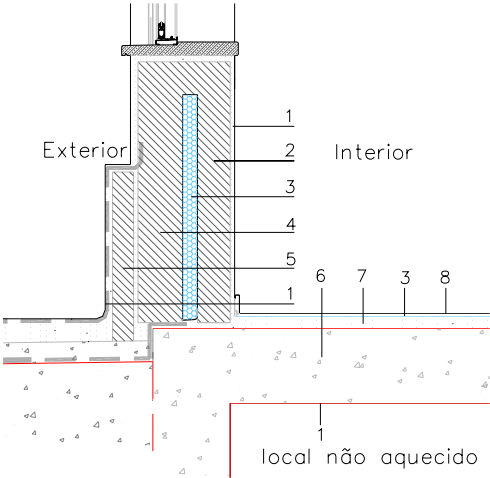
Ligação da fachada com pavimentos sobre locais não aquecidos (corte vertical).
